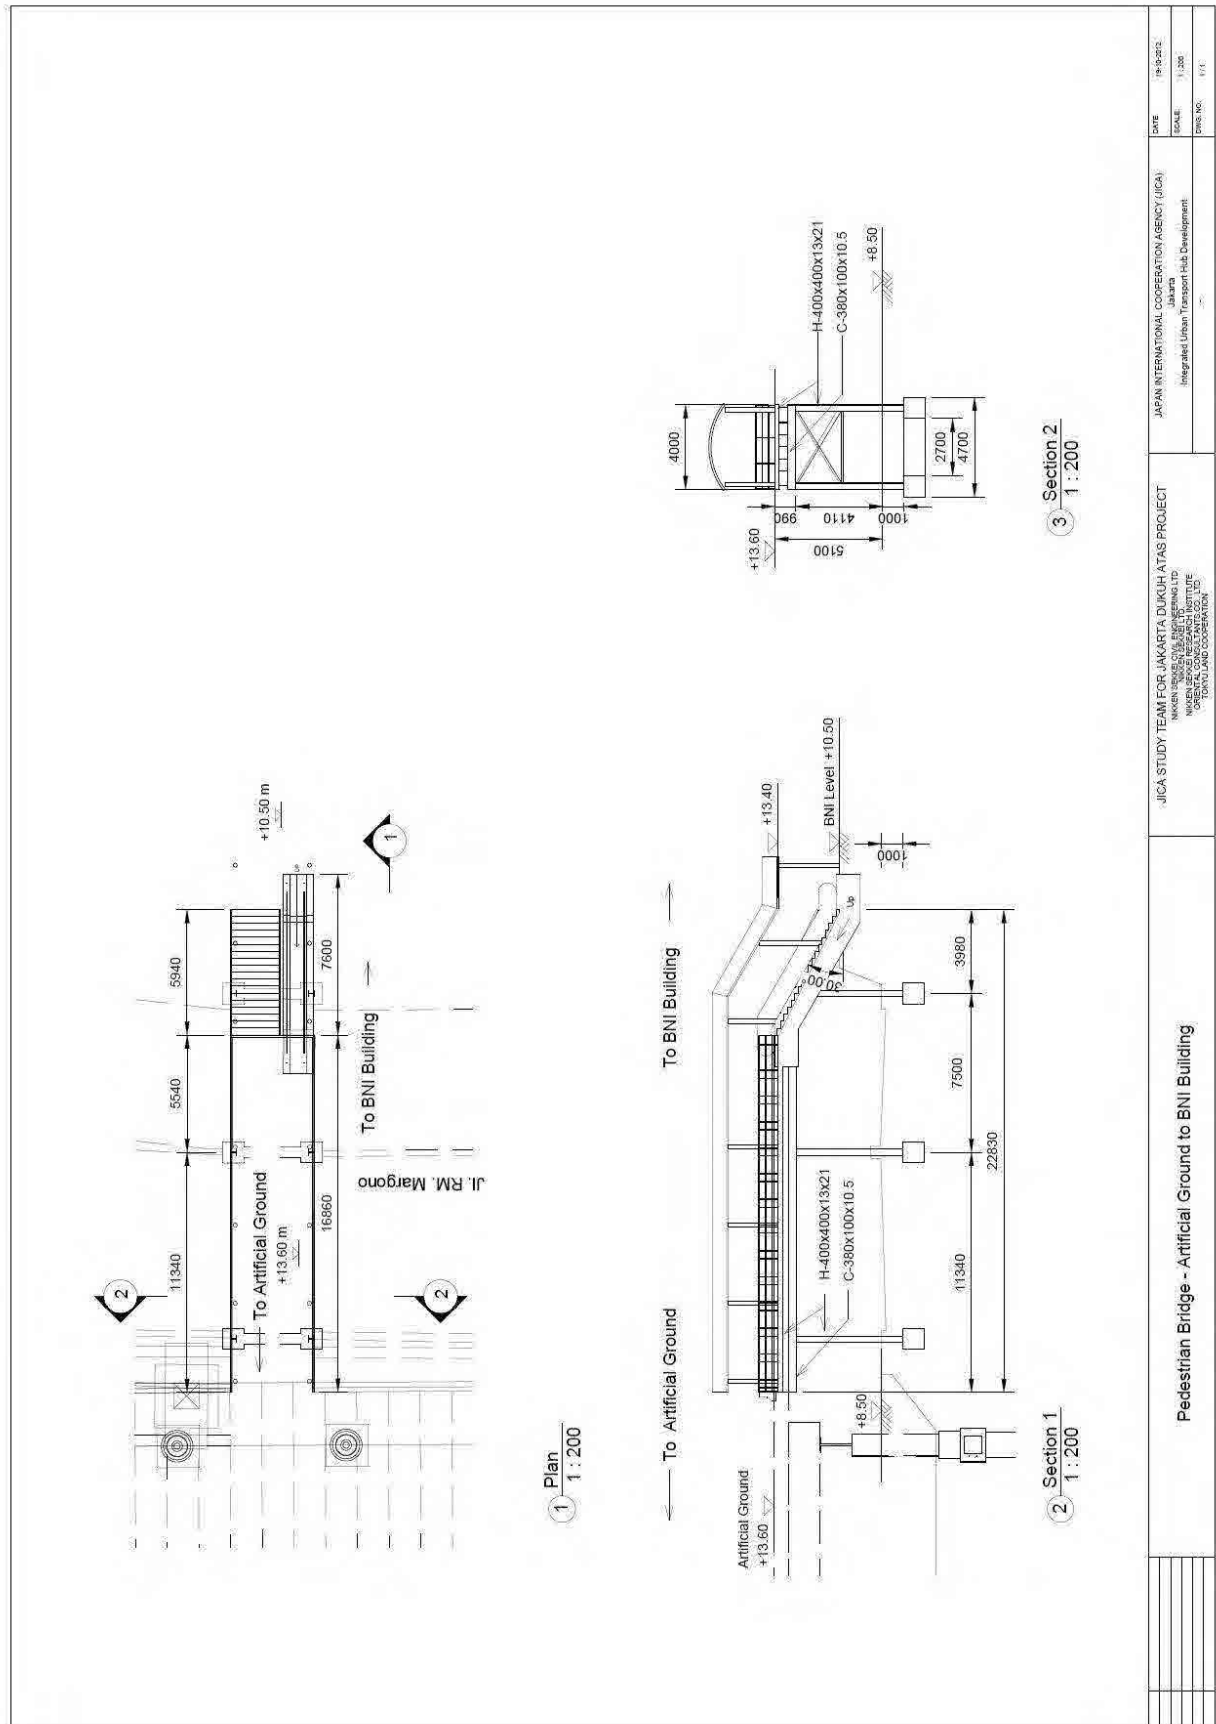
西側人工地盤－南西ブロック連絡通路平面図
